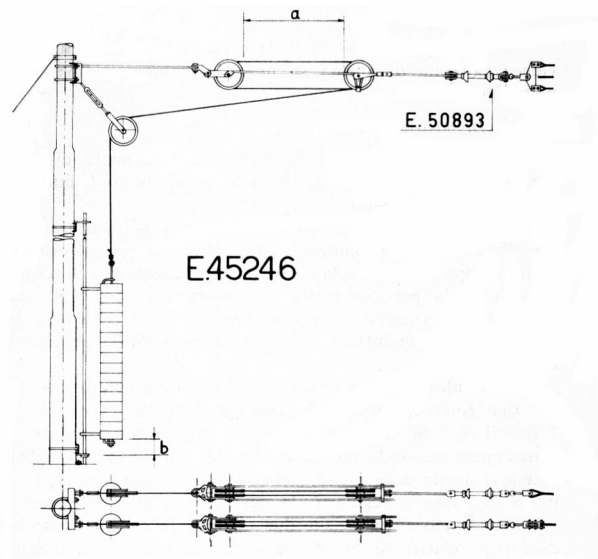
I – Palo LS 16a per ormeggio regolato con contrappesa tura. Fonte: RFI
